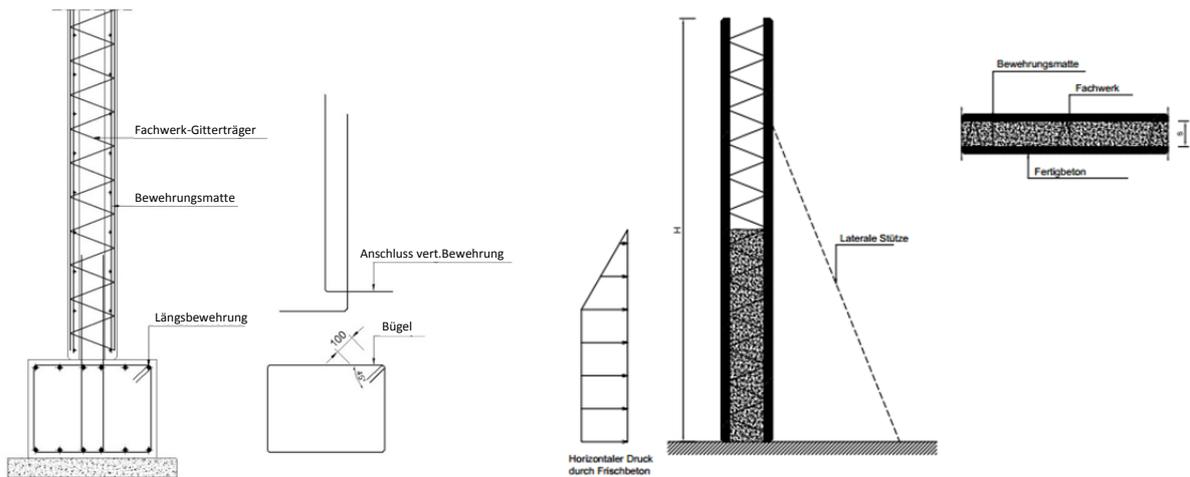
Typische Tragwerkdetails für den Anschluss zwischen Stahlbetonwand und Gründung (vertikaler Schnitt).
